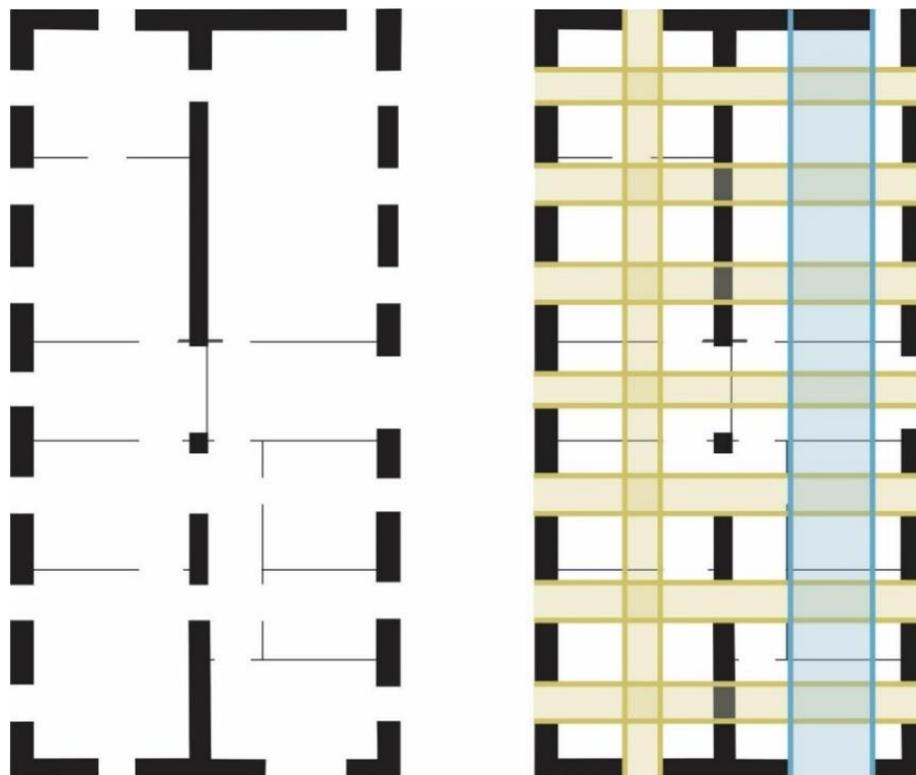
Planta baixa do 1º pavimento do Bloco II do PSC atual. Em amarelo são as simetrias entre as sacadas e, em azul, das portas.
